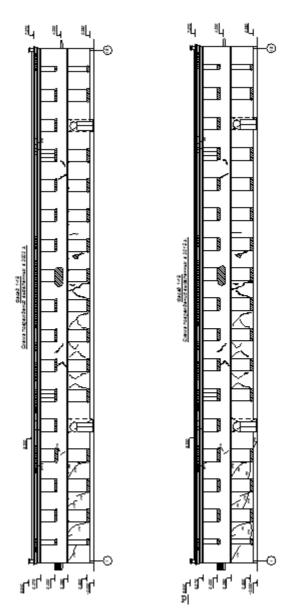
Схемы повреждений по фасаду в осях «1-18»
